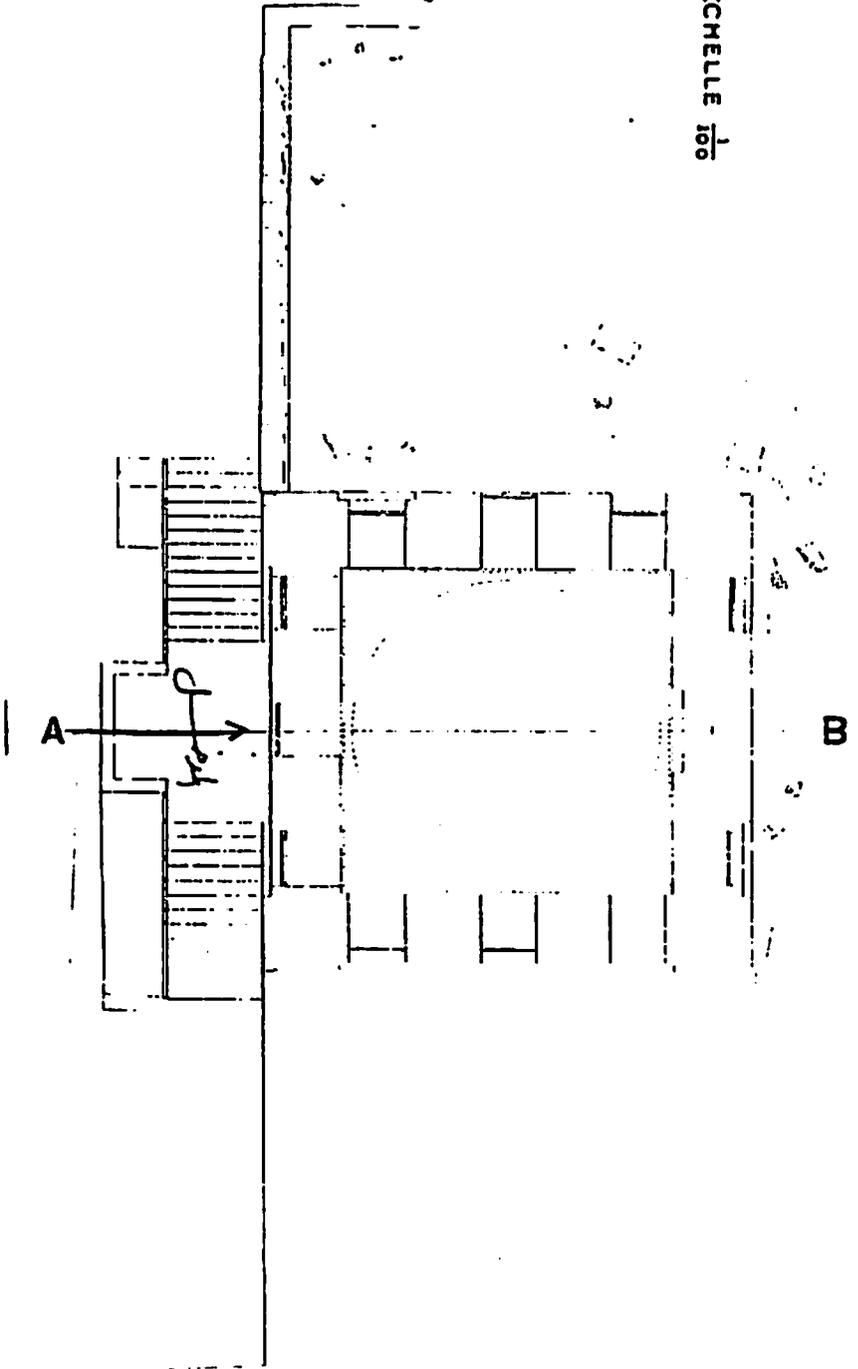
مسقط أفقي لقبة أزدمر عن هيئة الآثار
